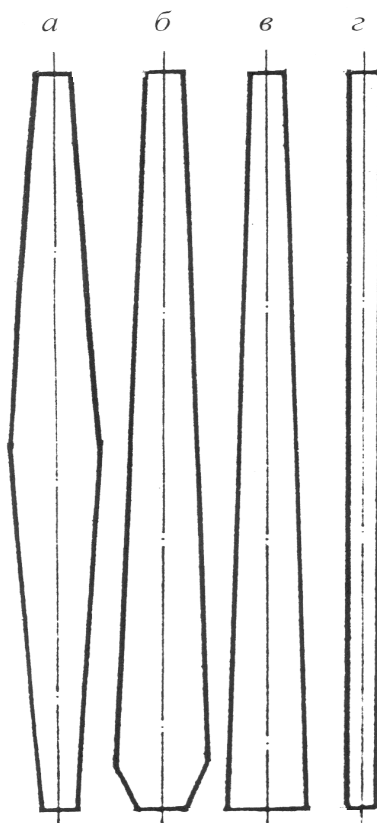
Форми поздовжніх перерізів залізобетонних паль:
